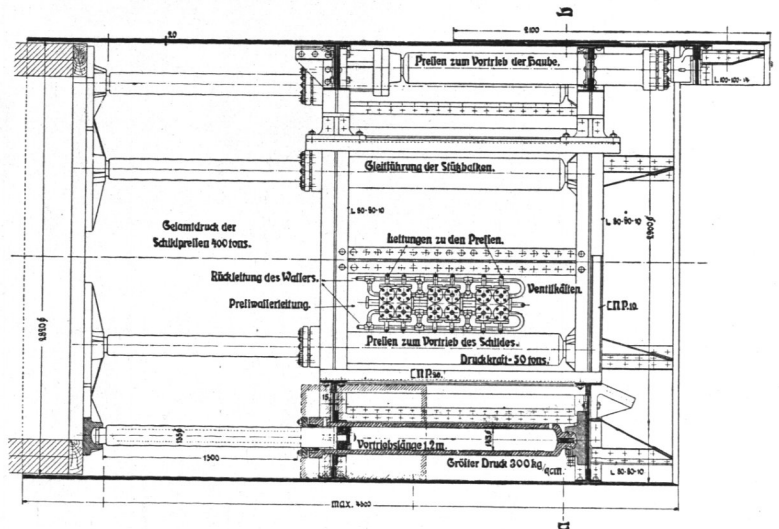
Tunnelstrecke der Bürgerweide, Brustschild, Längenschnitt.
